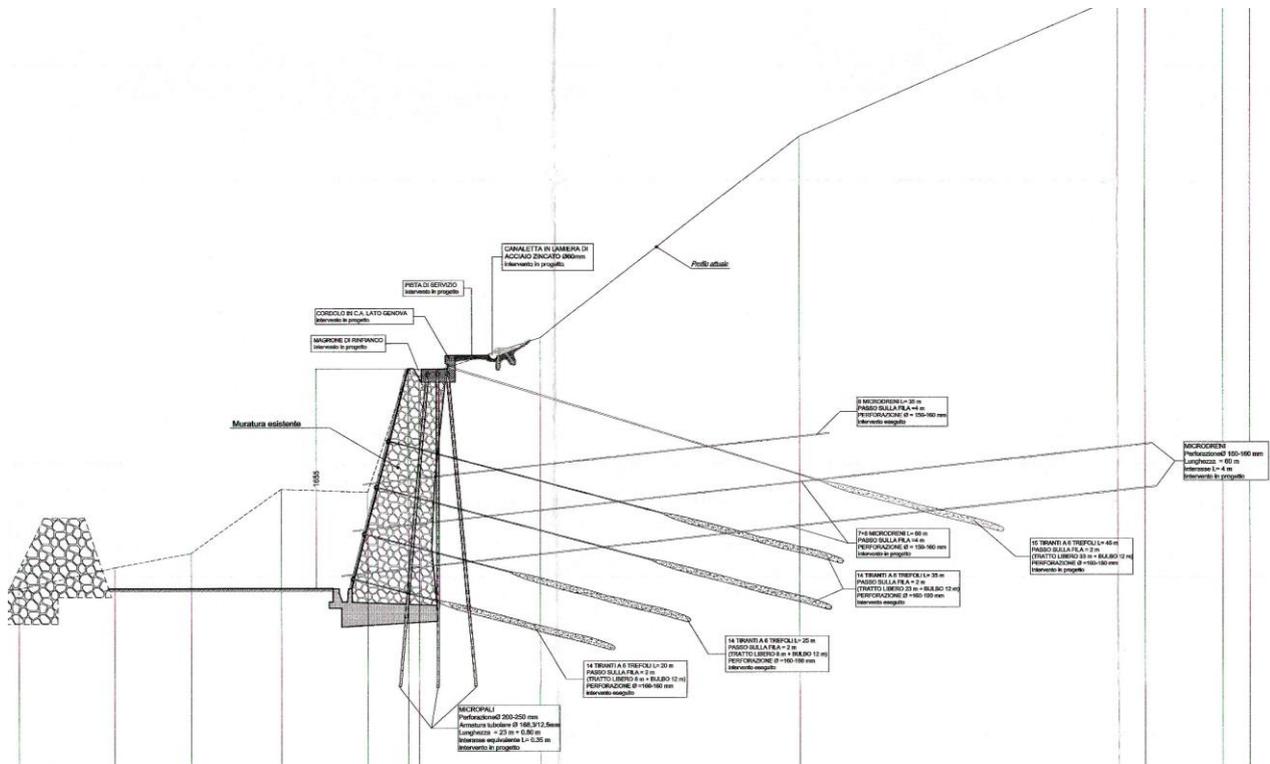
Stralcio di una delle sezioni di progetto 2003 per il tratto di muro consolidato.
